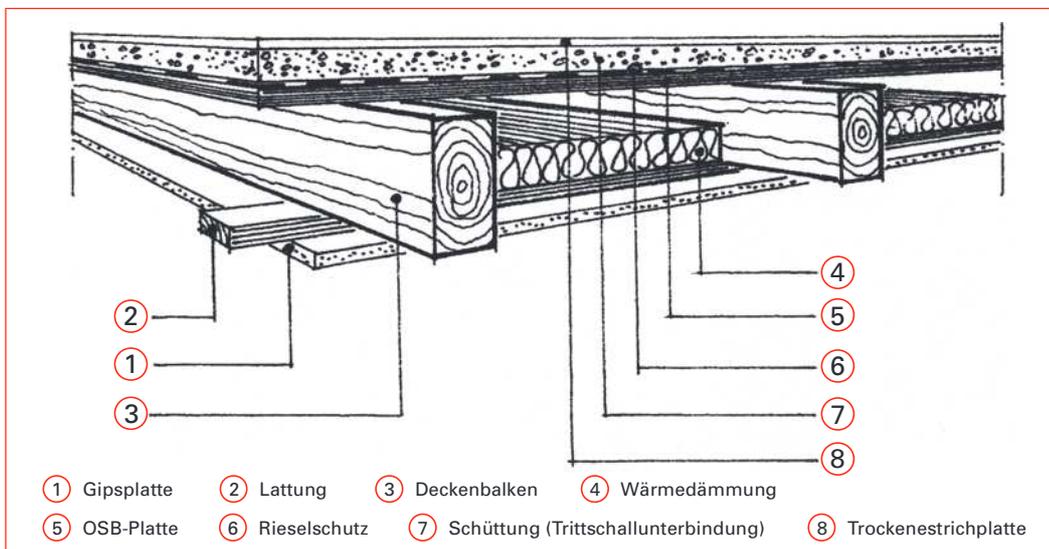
Aufbau einer Geschossdecke als Holzbalkendecke
